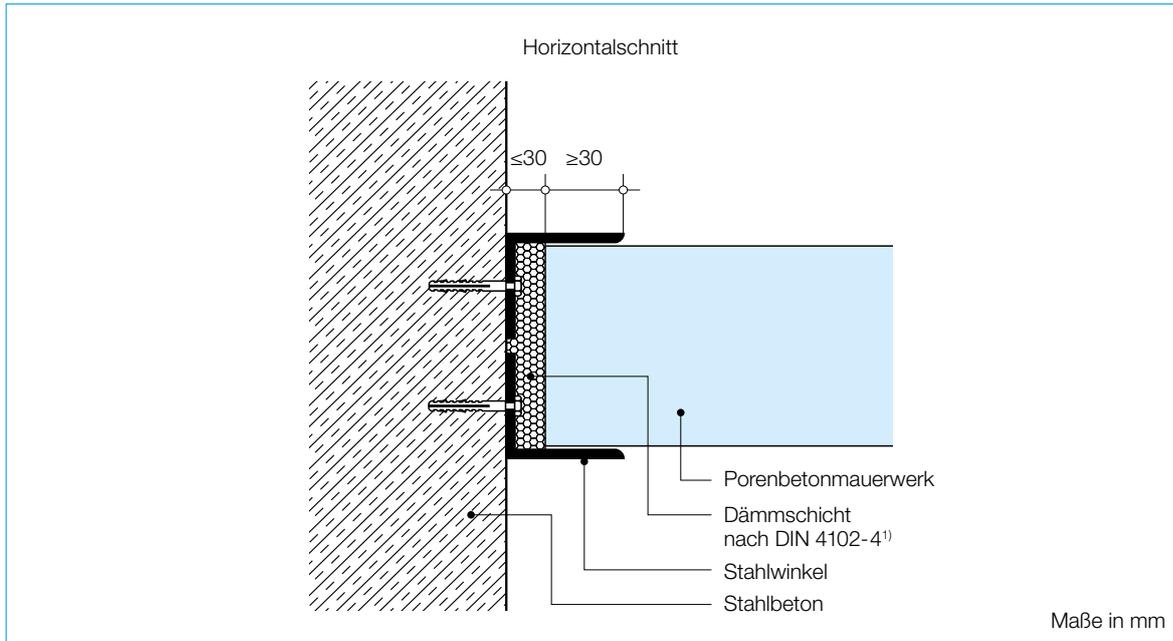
Seitlicher brandschutztechnischer Anschluss einer Wand aus Porenbetonmauerwerk an eine Stahlbetonwand mit Stahlwinkeln
